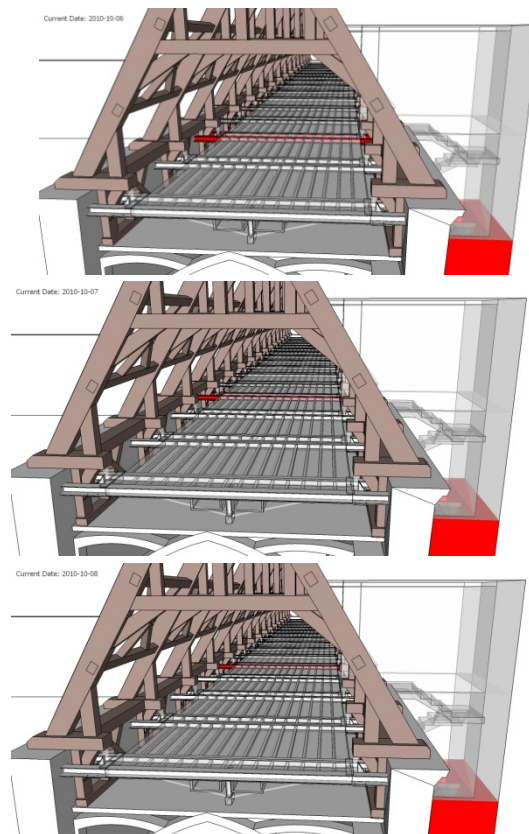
Succession de la mise en place de toutes les poutres de façon répétitive.
